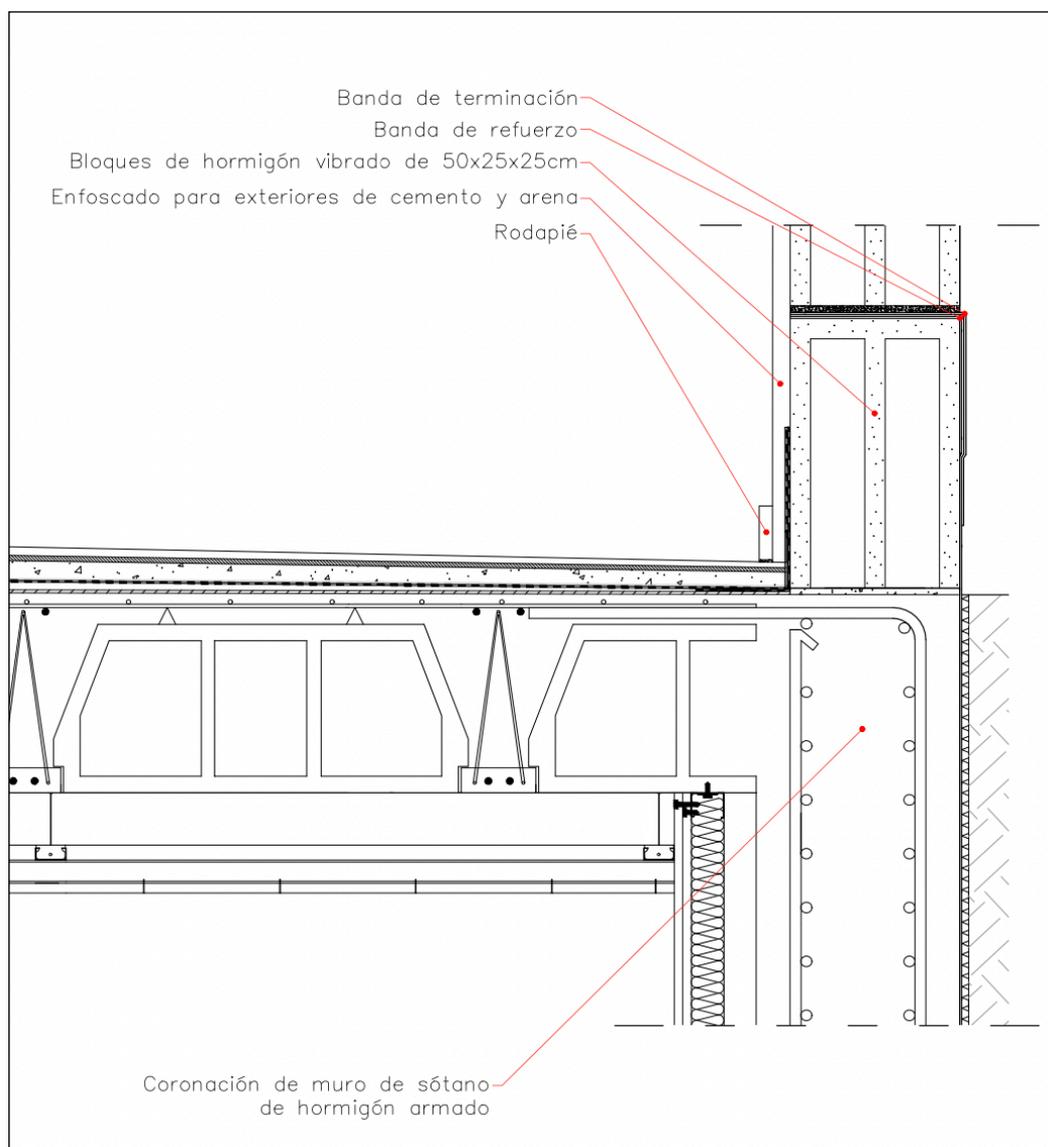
Detalle de encuentro muro flexoresistente y fachada.
